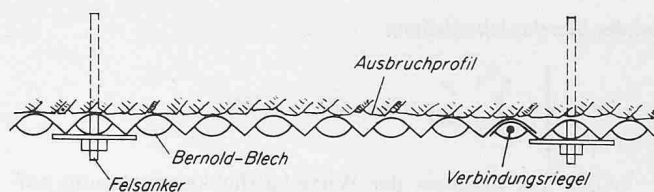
Sicherung einer gefrästen Felsoberfläche durch Bernold-Bleche
